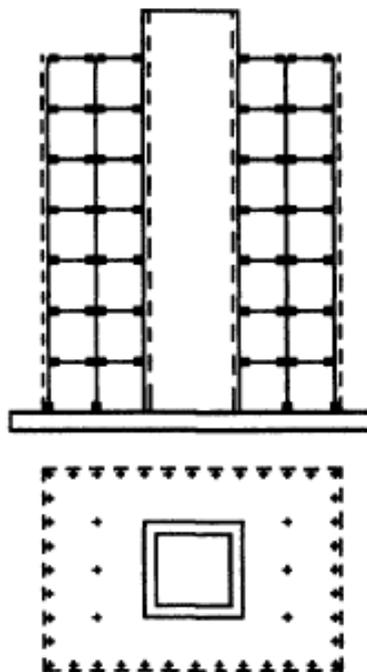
Связевой каркас с внутренним железобетонным ствол жёсткости
